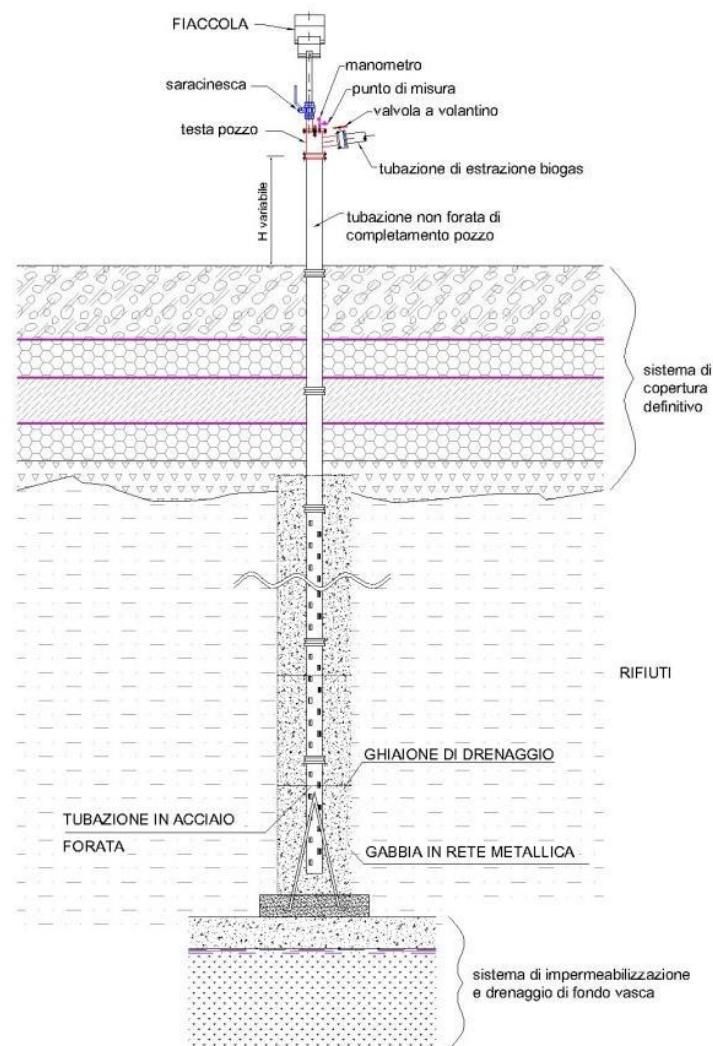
Schematizzazione di un pozzo verticale in crescita
